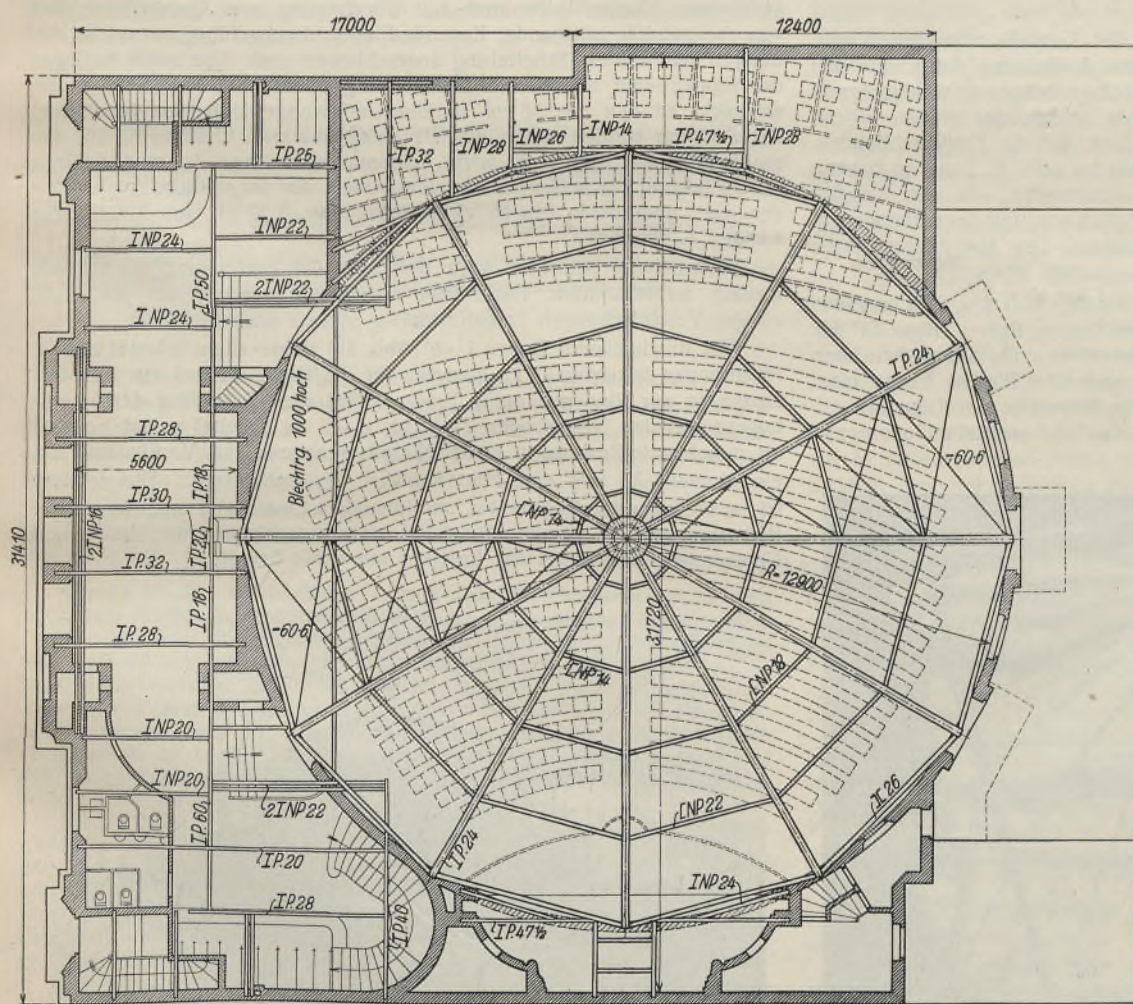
Kino in Hannover. Grundriß des Erdgeschosses mit Gestühlungsplan und Aufsicht auf die Trägerlage des Zwischenstockes und die Kuppelkonstruktion.
